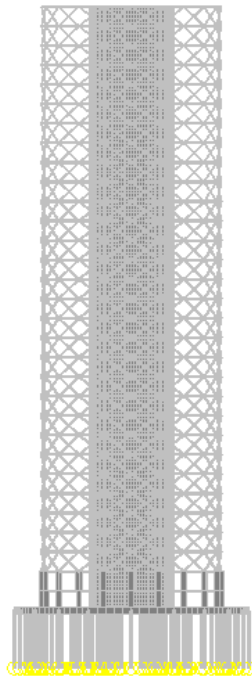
Расчетная схема здания в ПК SCAD
